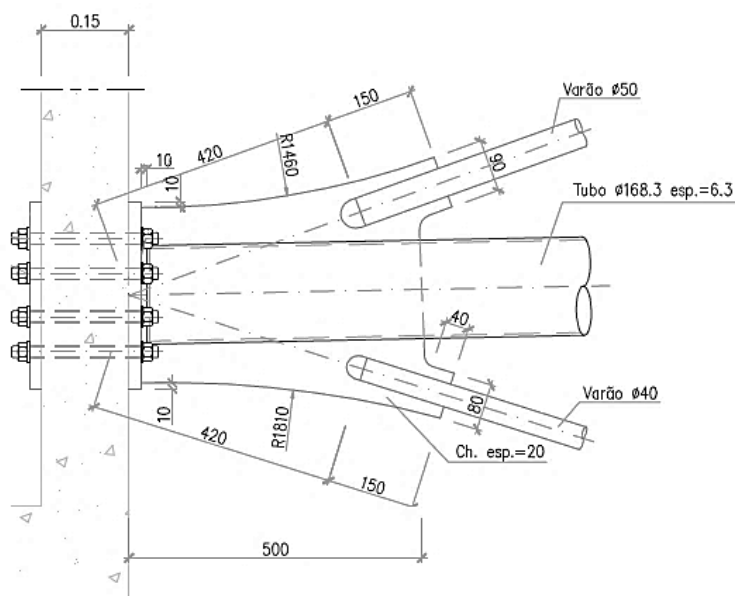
Pormenor construtivo de uma ligação utilizando um *gousset* atravessando um tubo CHS (Cima Gomes; Biscaia, N., 2008)
